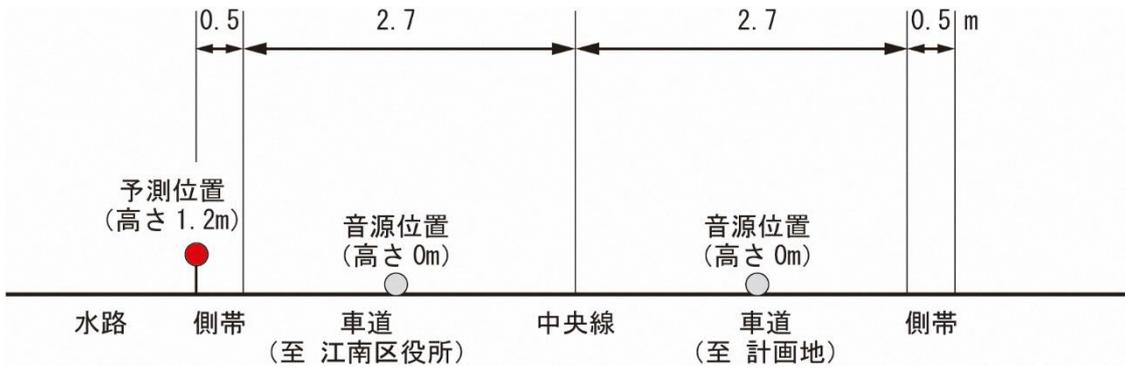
(4) 道路断面図 (No.4 : 新施設西側沿道)
